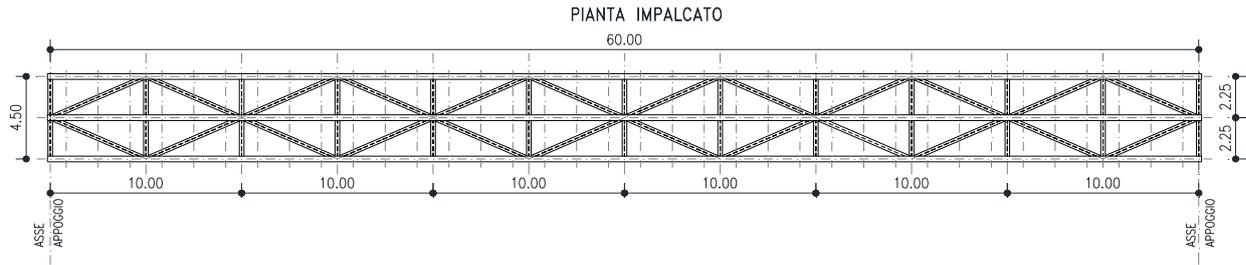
Progetto: vista in pianta delle strutture di impalcato
